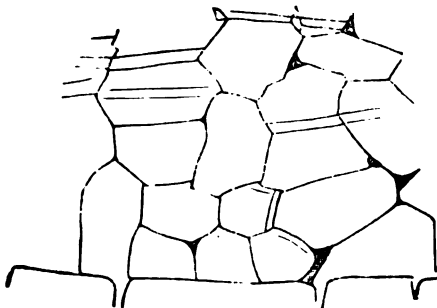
Chaussée dallée d'une rue de Pompéi.
